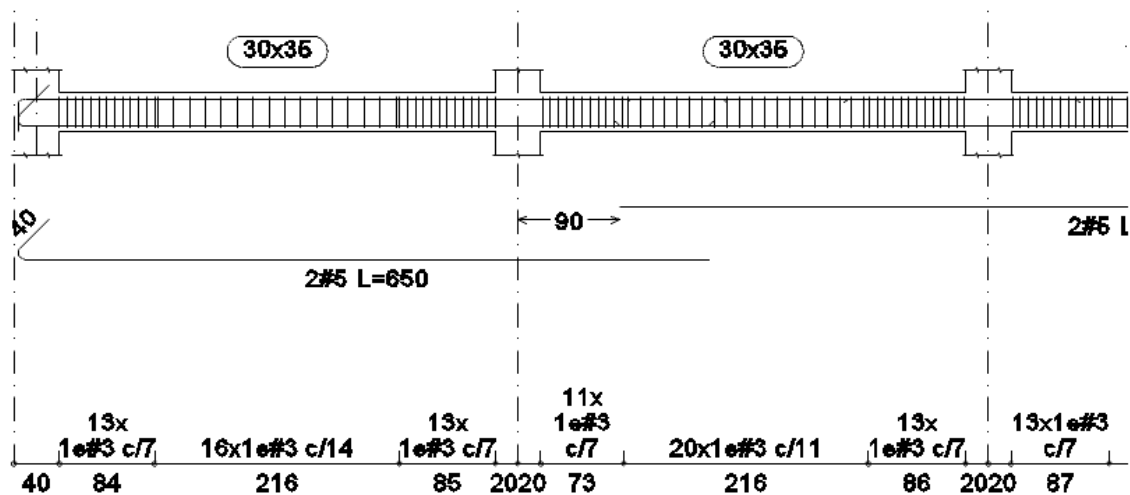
Planos de distribución de aceros en vigas V2 de entre piso. Fuente: Arquitecto.
